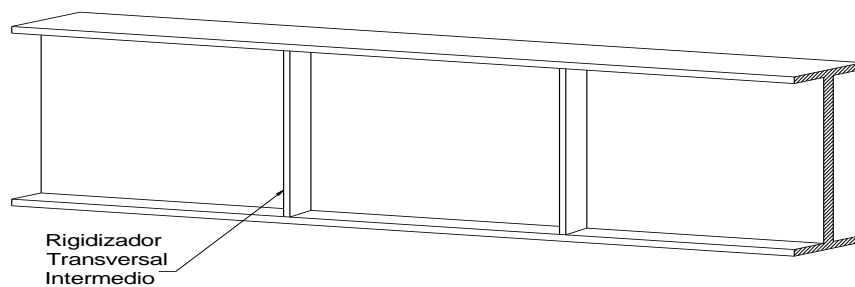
Rigidizadores transversales intermedios a lo largo de la viga
